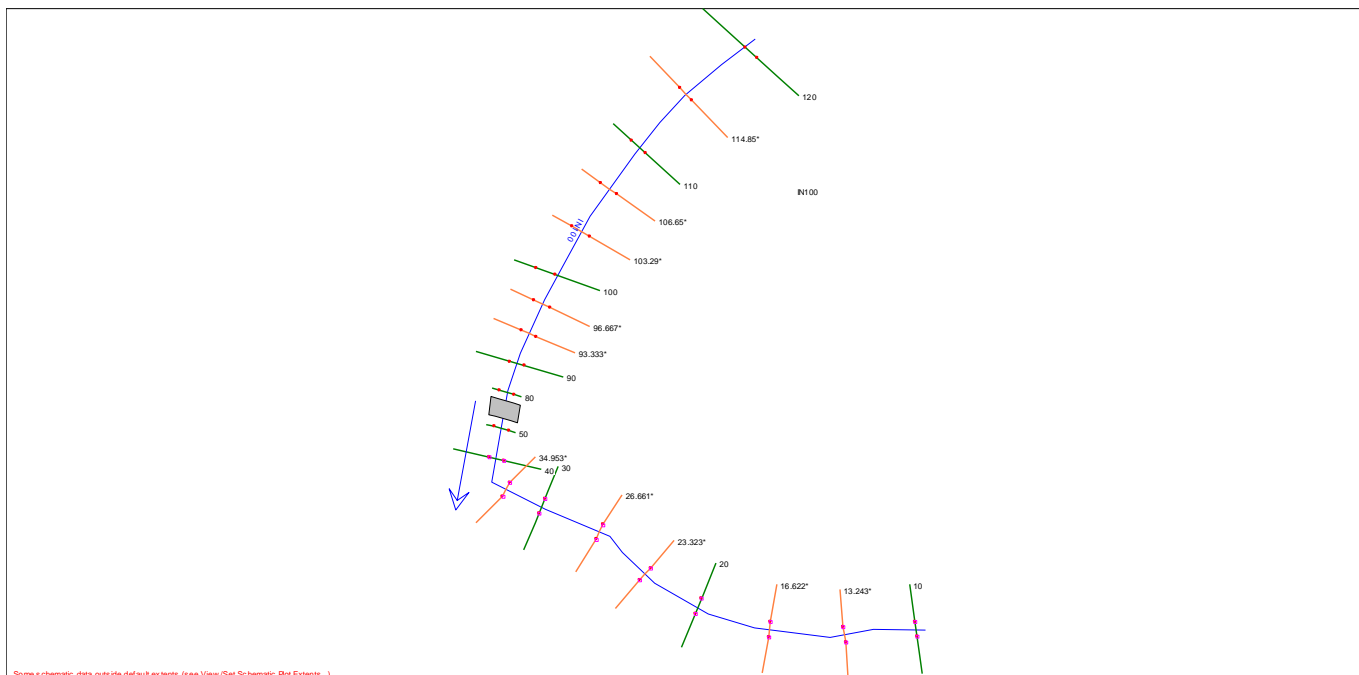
Planimetria modello 1D – stato di progetto interferenza IN100.
